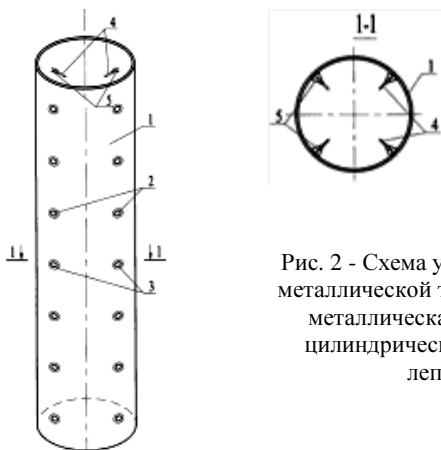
Схема уплотнения бетонной смеси в металлической трубе через отверстия, где 1 - металлическая труба, 2 – отверстия, 3 - цилиндрические выемки, 4 - анкера, 5 - лепестковые муфты
